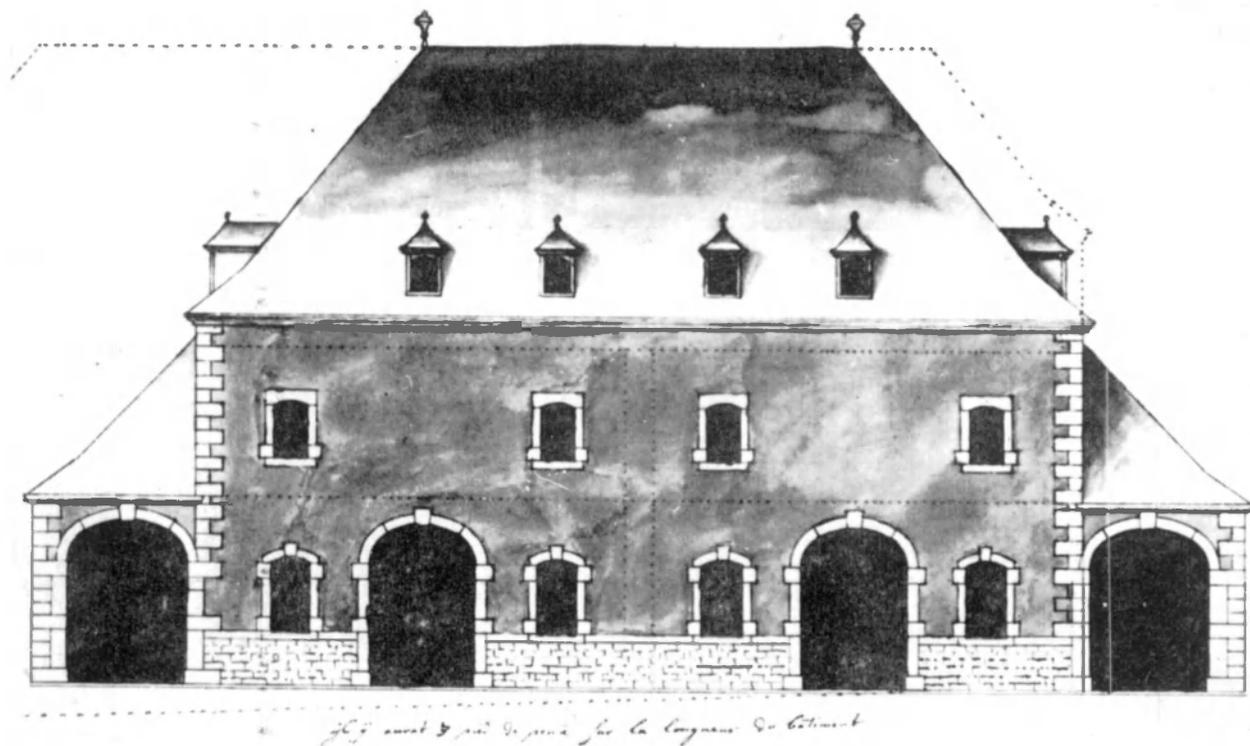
Plan de Chermans (élévation de l'orangerie).
